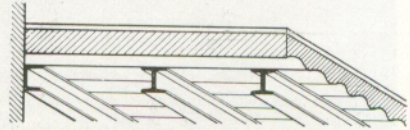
Schutzraumdecke aus Stahlrohr-Betonbalken (DRP.).
